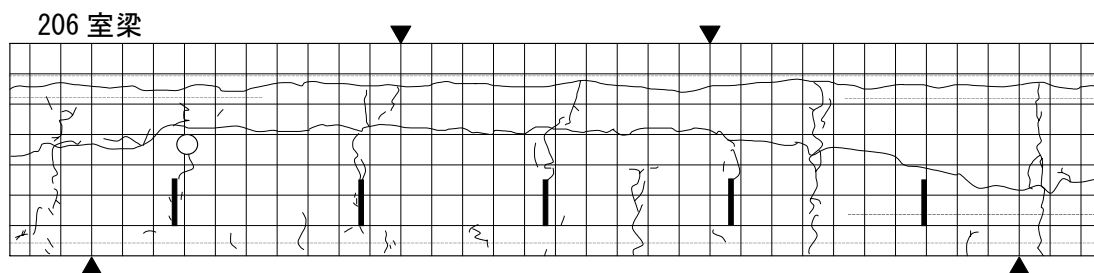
加力前のひび割れ状況 (206 室梁)
